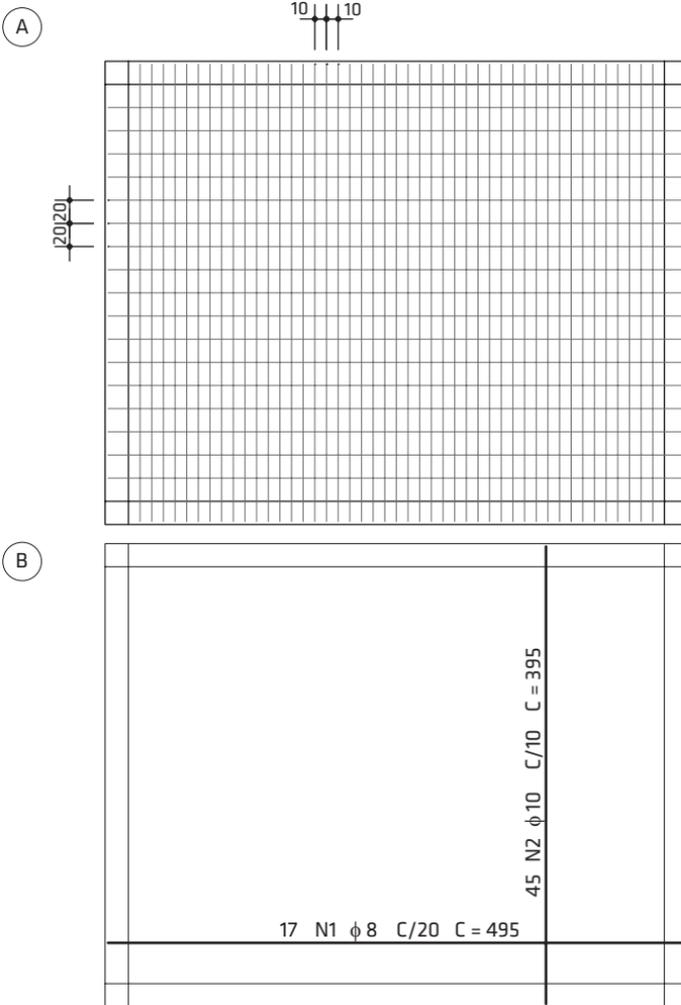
Representação de armadura de lajes: (A) com todas as barras desenhadas; (B) com a codificação adotada nos projetos estruturais
